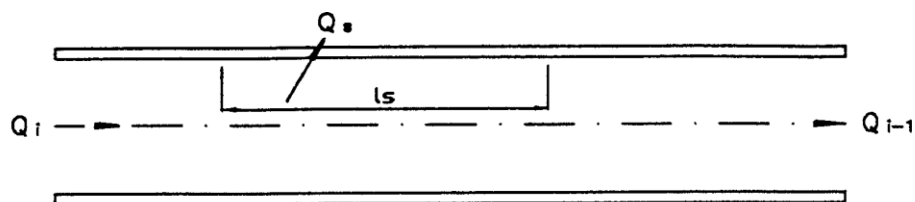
Grundriss eines geraden Streichwehres
